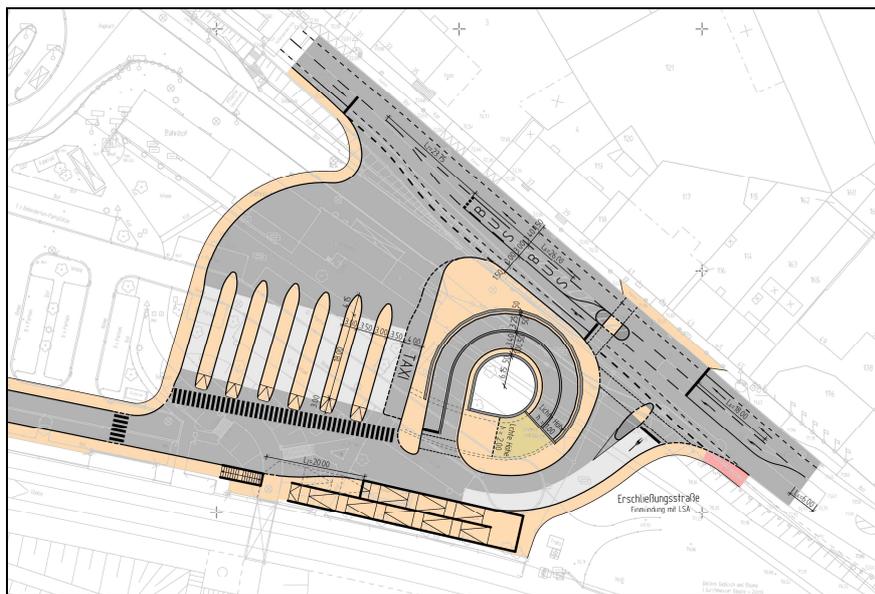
Alternative Erschließungsvariante Bahnhofsareal (Auszug, Schwietering Verkehrstechnik und Straßenplanung, Stand 15.11.2016)
